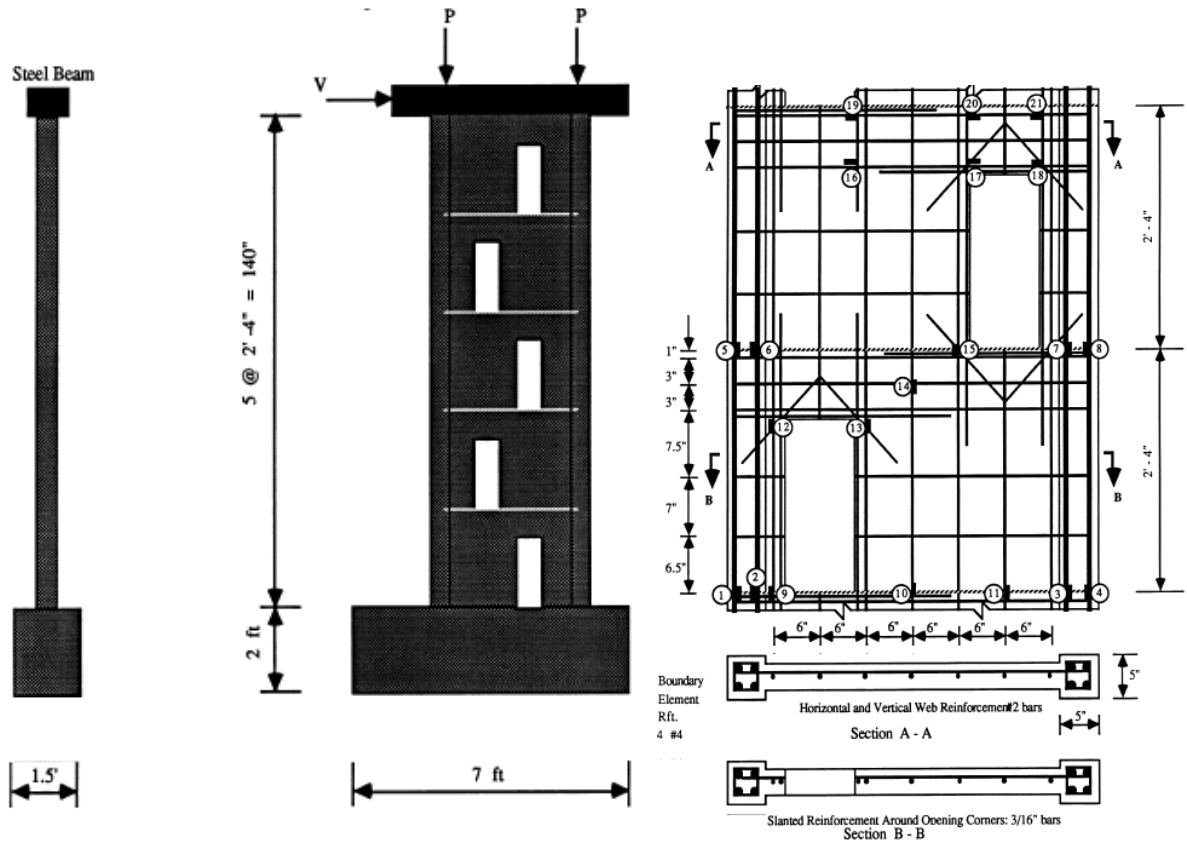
Muros con aberturas W-2, W-3 y W-4.
